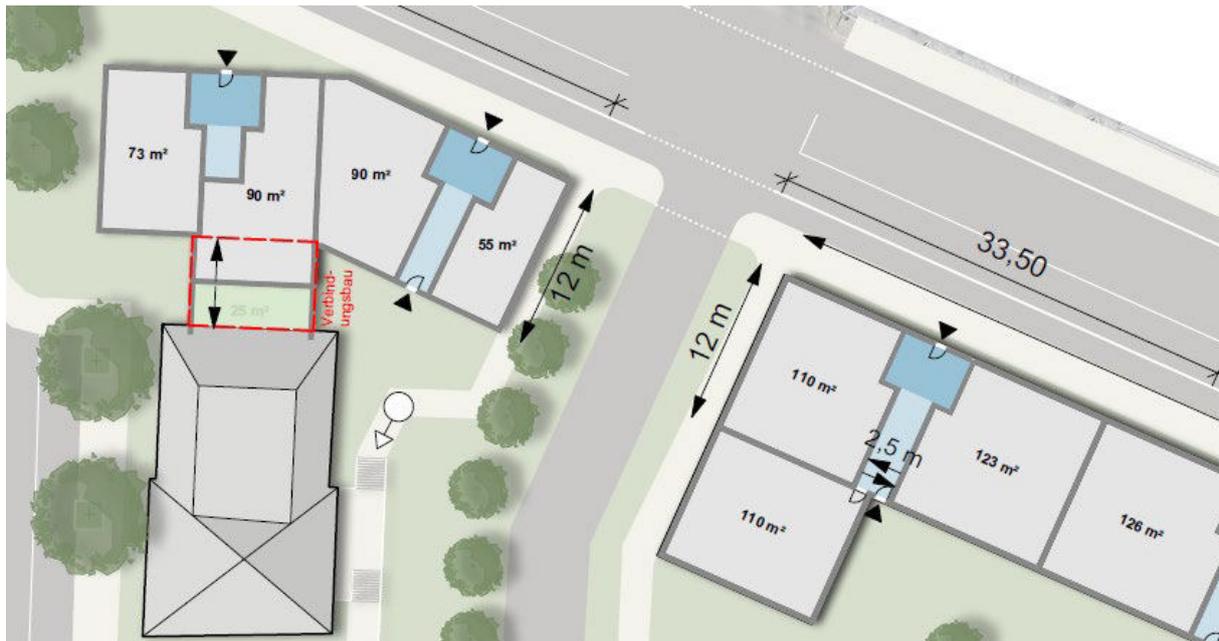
Funktionsgrundrisse Mischnutzung - Detailausschnitt (o.M.)
